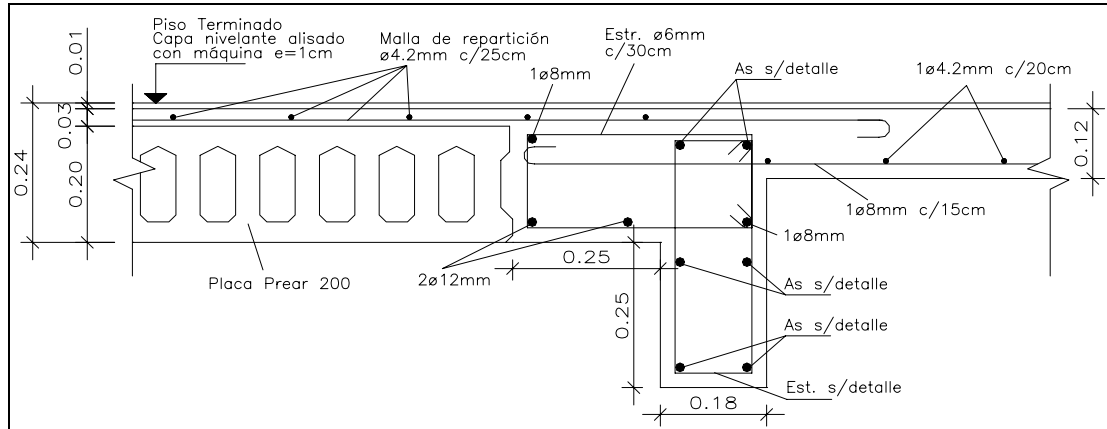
Detalles generales de las placas prefabricadas utilizadas como losas de entrepisos y cubierta de techo.
